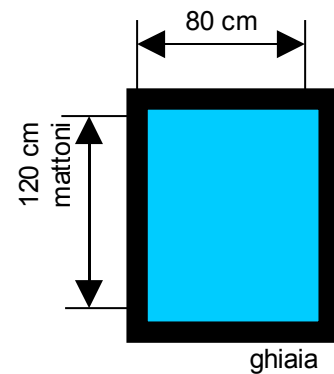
Planimetria riassuntiva delle sezioni esaminate
